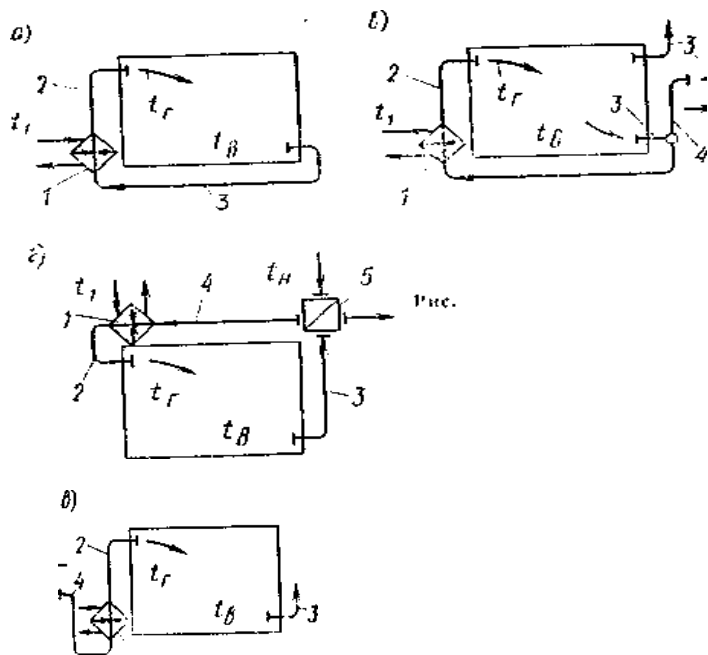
Принципиальные схемы систем центрального вентиля-ционное отопления.
